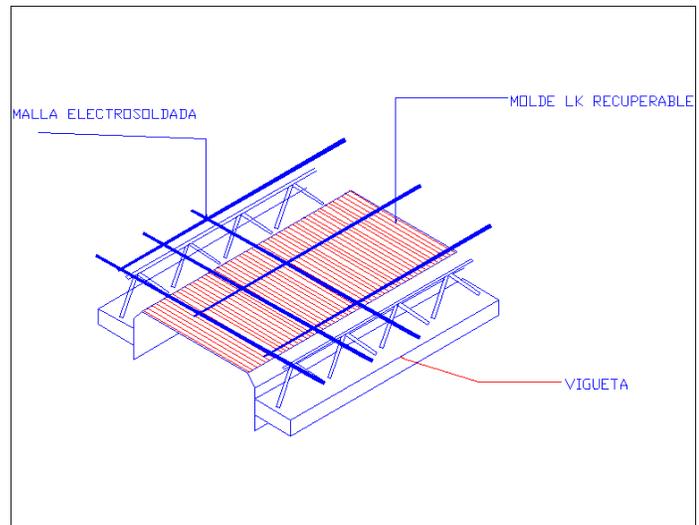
Composición de sistema de losa con viguetas pretensadas y molde metálico recuperable.
